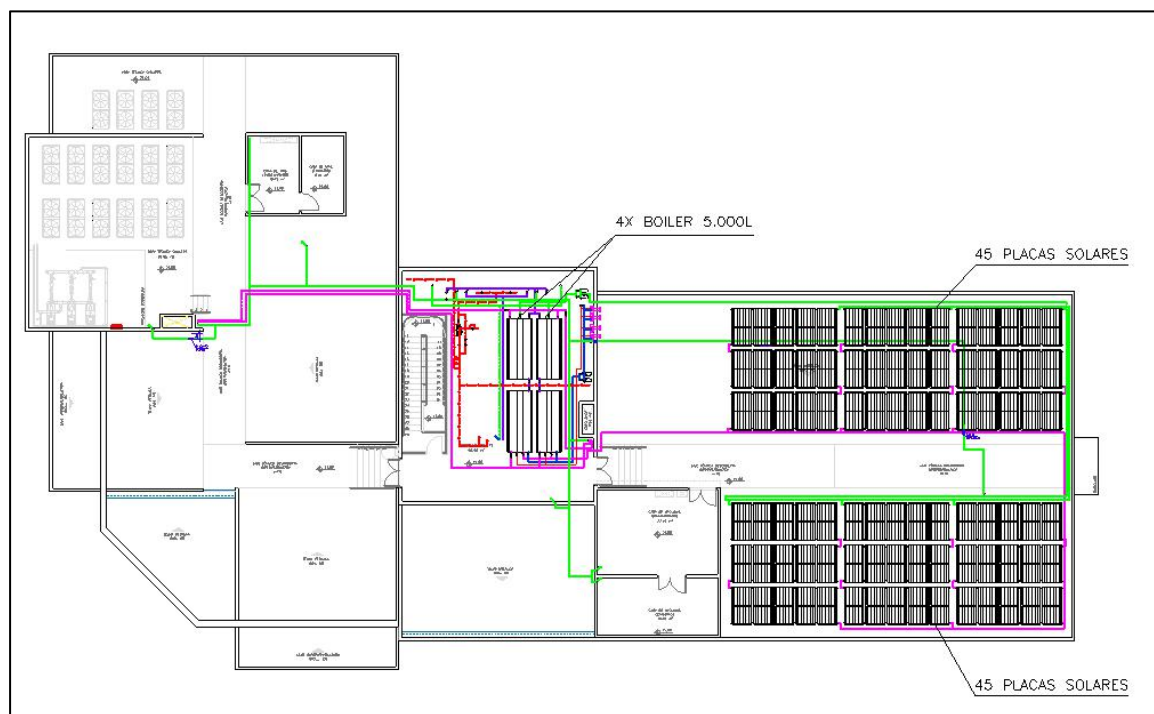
Locação dos coletores e reservatórios na planta do pavimento técnico
